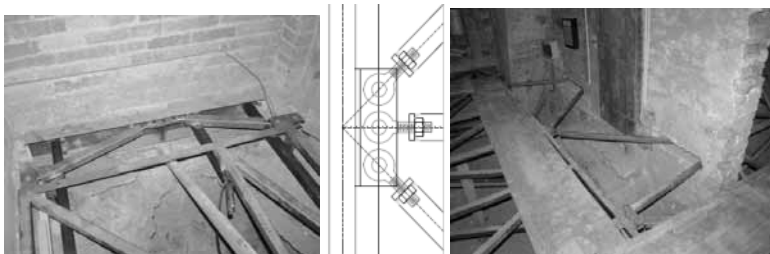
Dettagli dell’ancoraggio al muro delle reticolari mediante elementi a biella regolabili.
